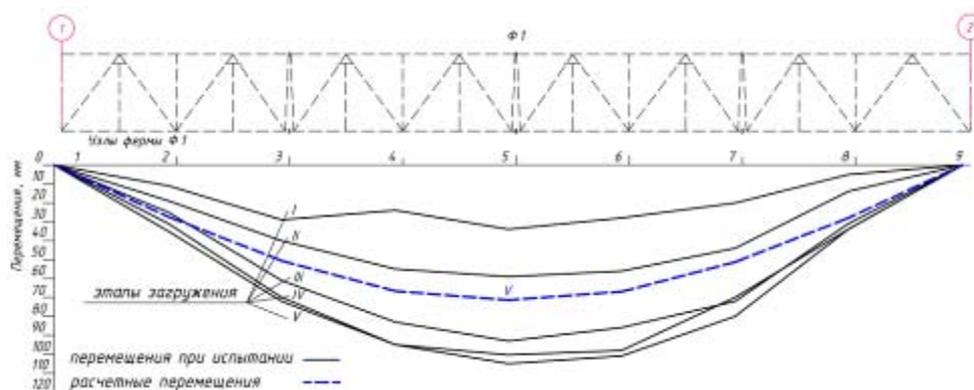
Вертикальные перемещения нижнего пояса фермы Φ1
